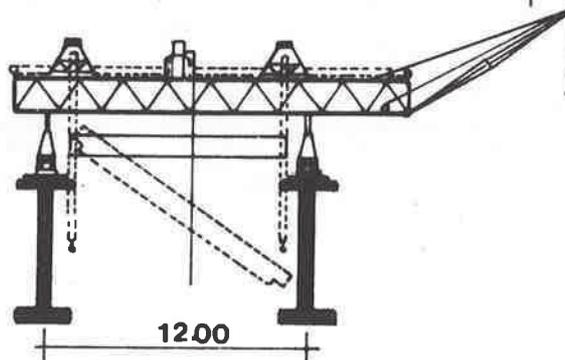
Il traliccio di varo per la movimentazione delle piastre prefabbricate
